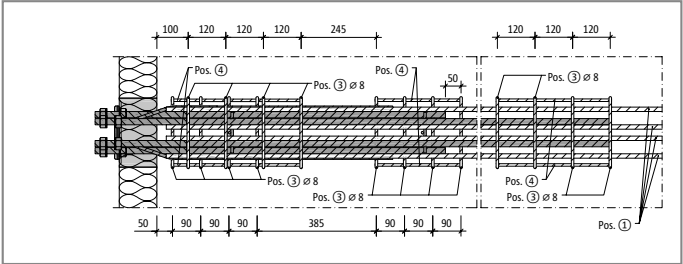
Bauseitige Bewehrung (Bügel und Übergreifungsbewehrung) beim Einsatz des Schöck Isokorb® XT Typ SK-MM2-VV1 – Grundriss
